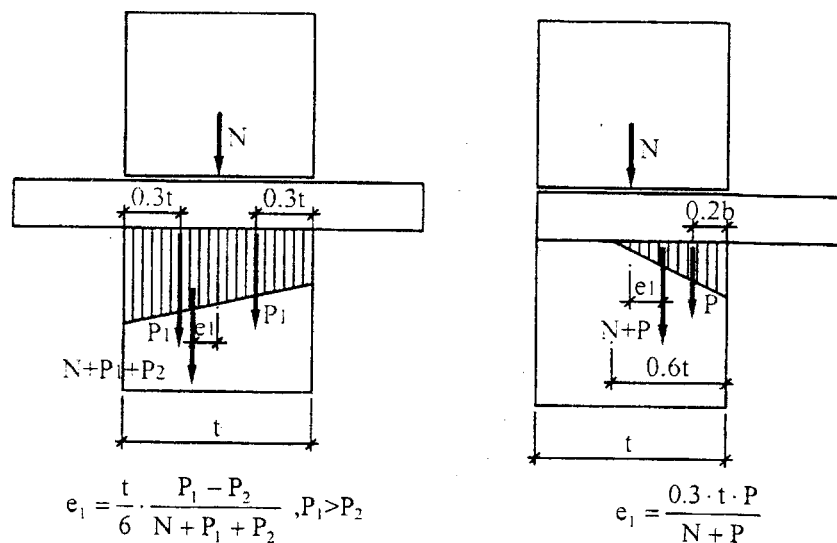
Stabilirea încărcărilor pe pereți
